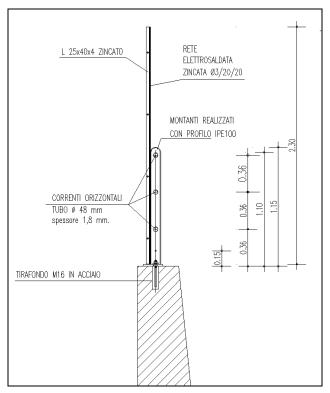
Particolare del parapetto posto sulla sommità dei muri di contenimento
